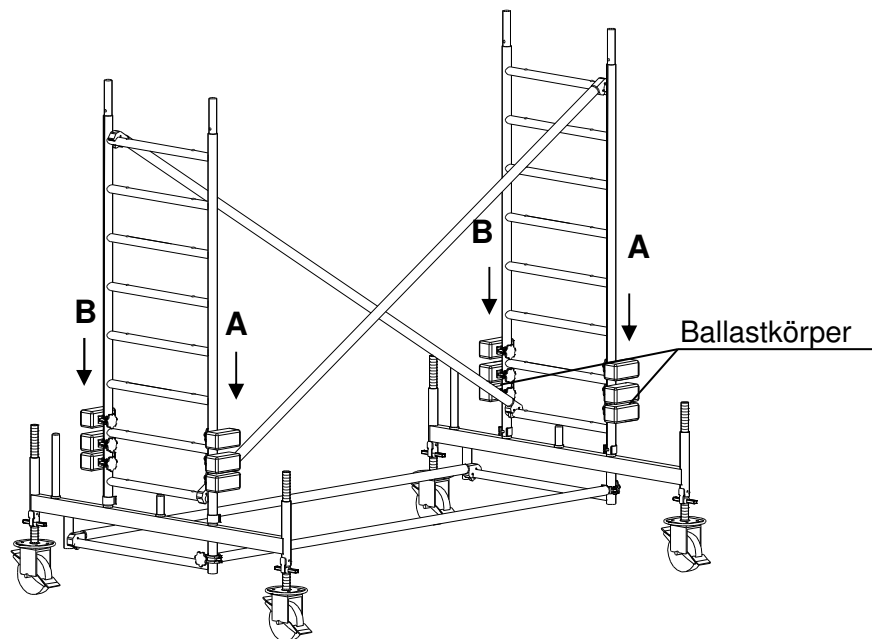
Grundeinheit mit Fahrbalken L180 und Ballast
